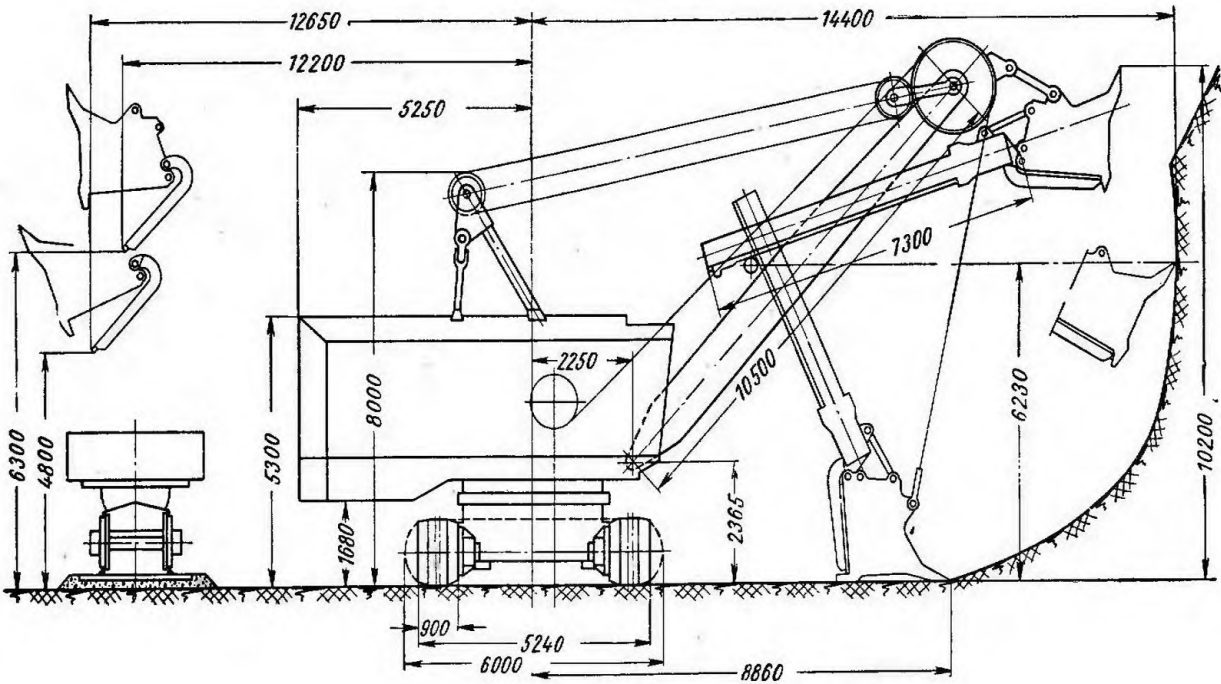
Рабочие и габаритные размеры экскаватора ЭКГ-4,6А
